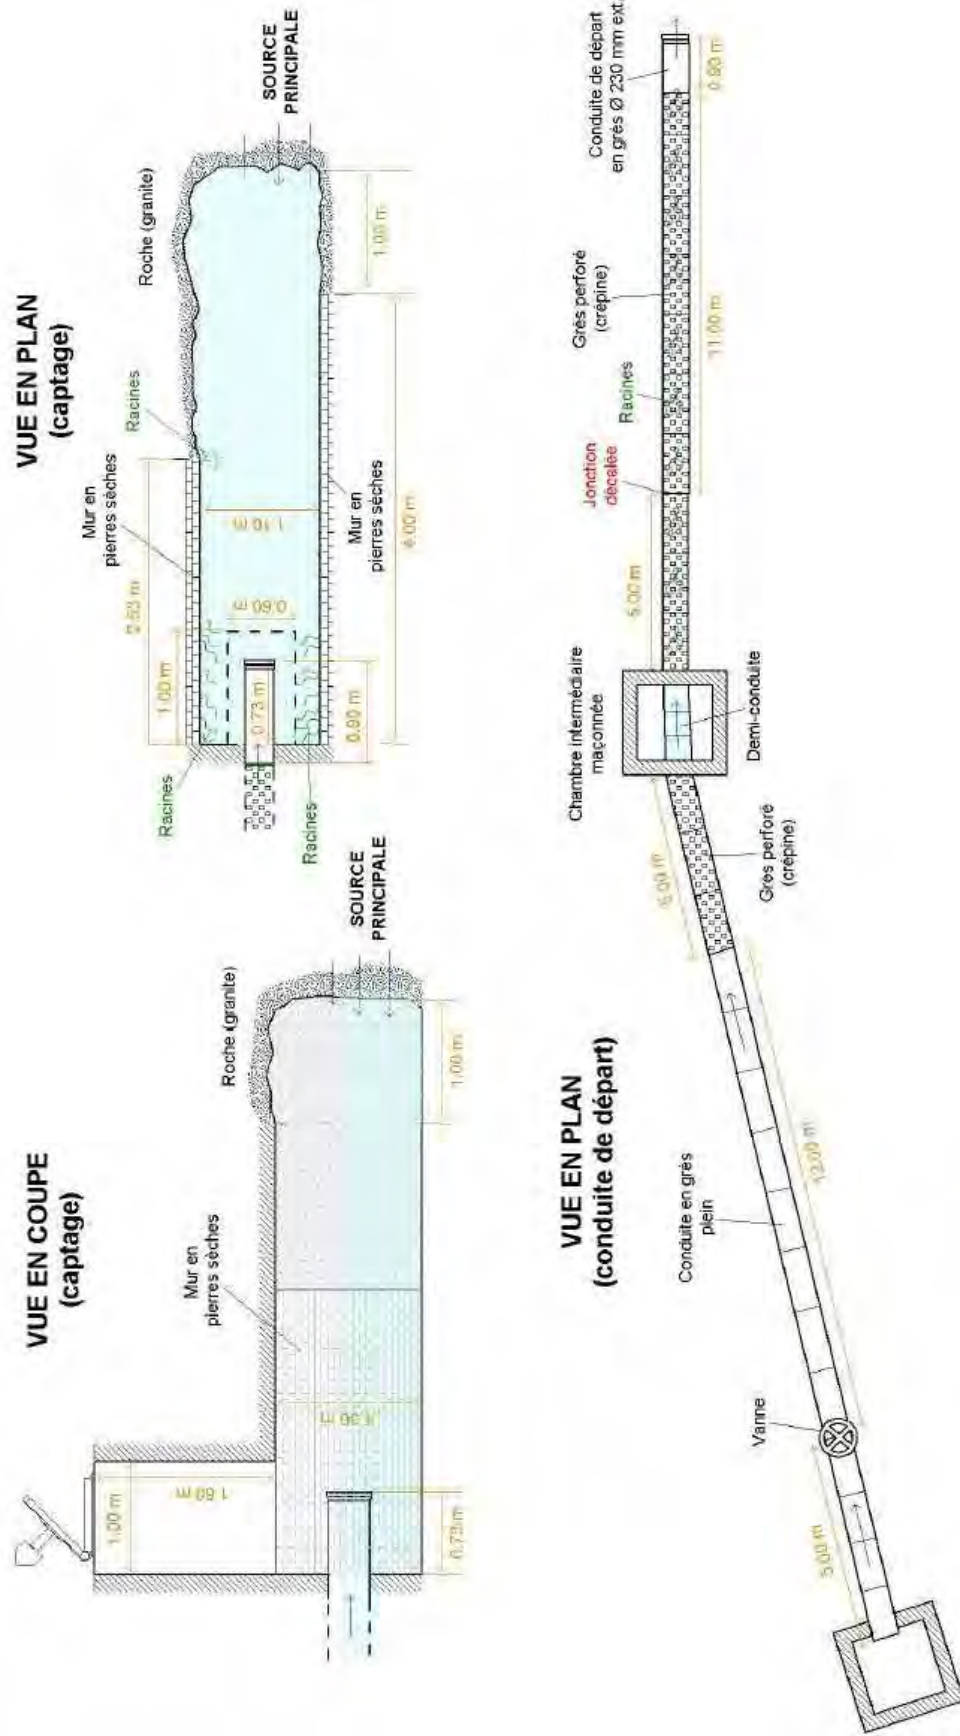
Coupe et plan captage du Pêcher (d'après CPGF septembre 2021)
